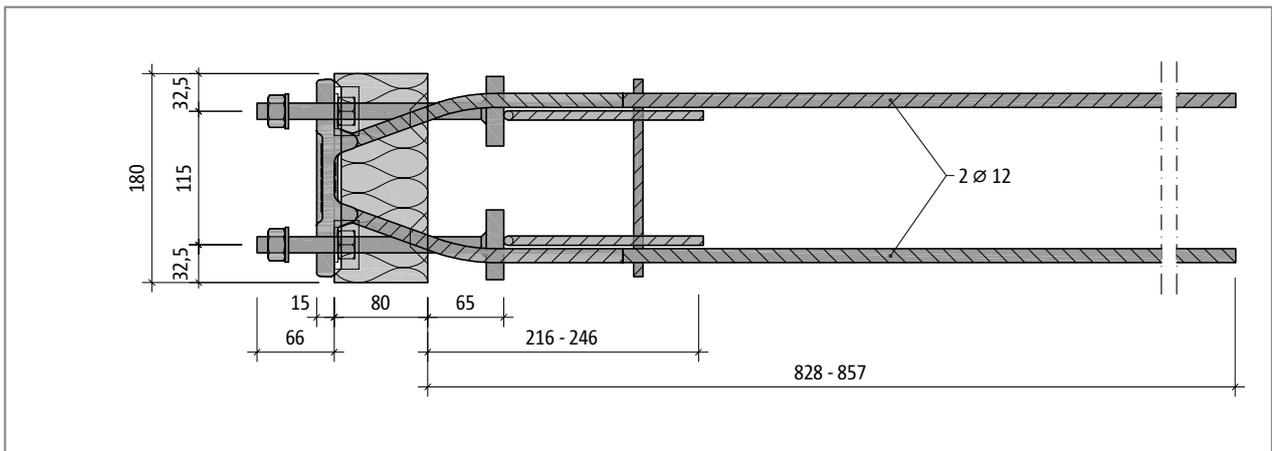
Schöck Isokorb® T Typ SQ-V3: Grundriss
